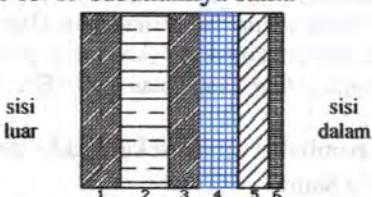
Susunan Lantai Frame 11-15 Dan 15-19 Desain A
